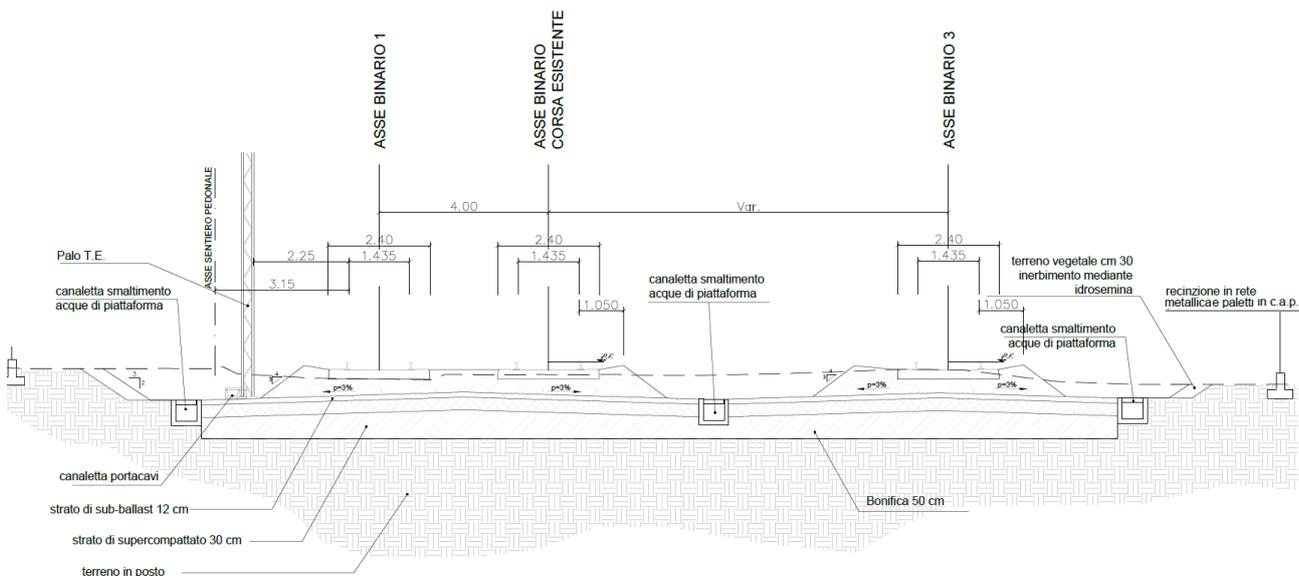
Dettaglio della precedente sezione (riquadro rosso)
